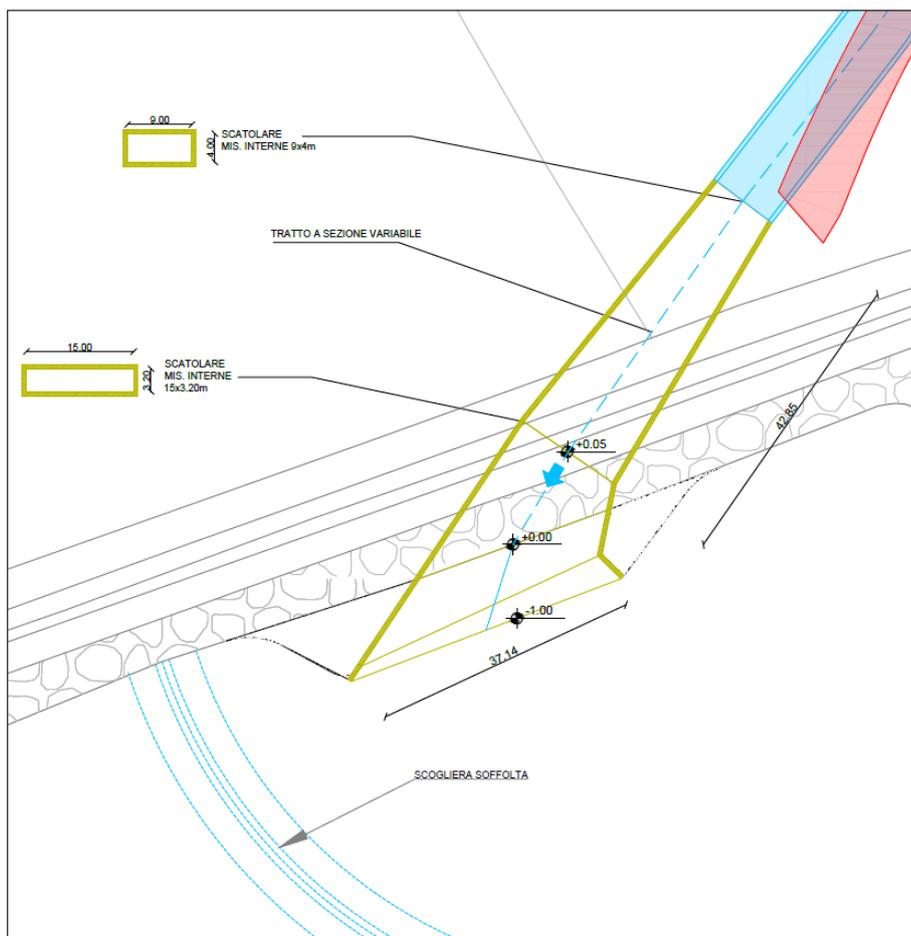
Stralcio planimetrico sbocco a mare (PFTE)
